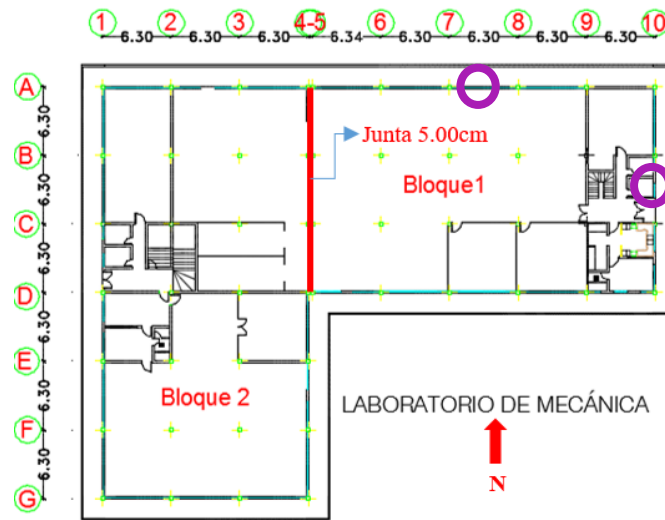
Ubicación en planta de acelerómetros en Bloque 1
